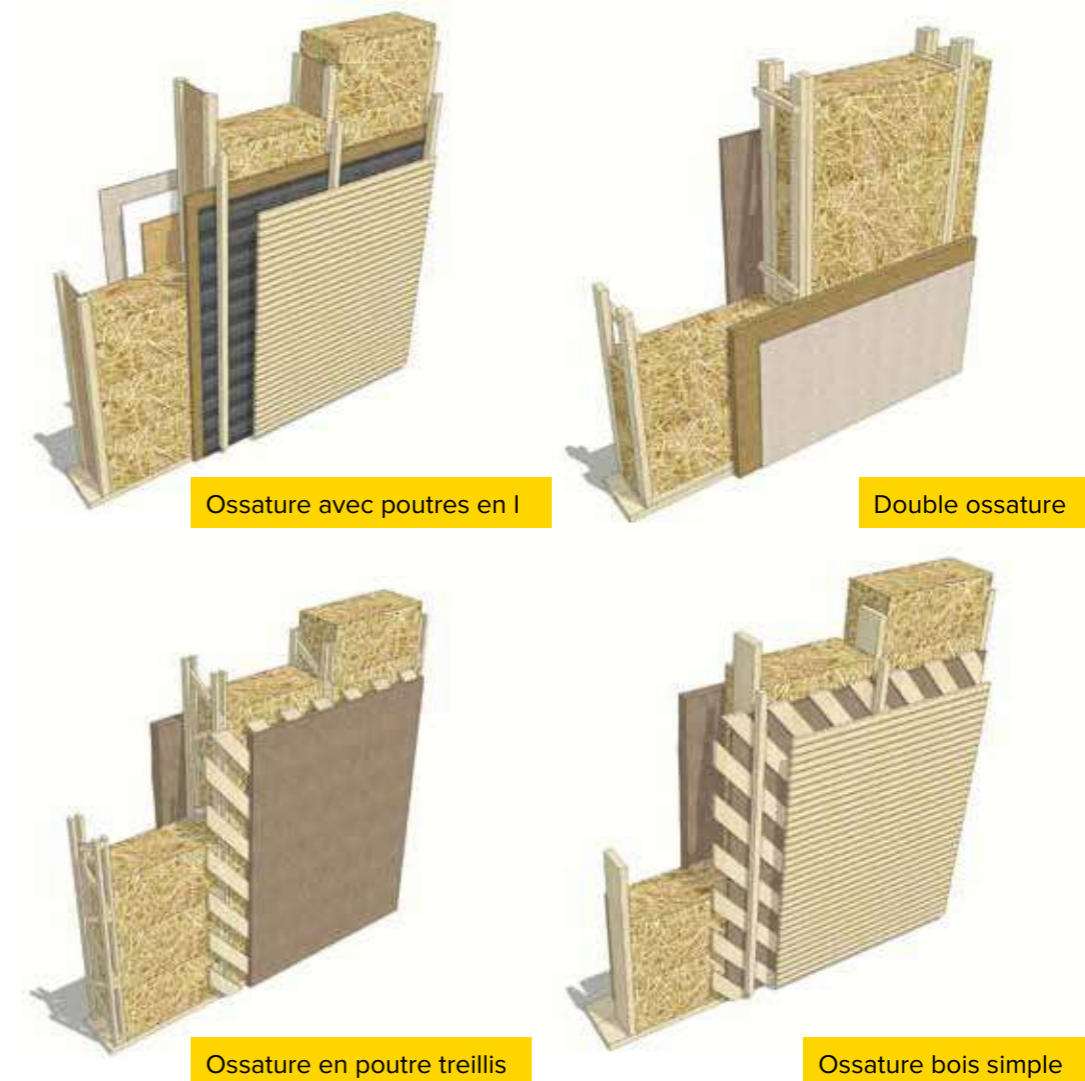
Exemples de Systèmes constructifs utilisant les bottes de paille (Source: © KOVAC architekt)
